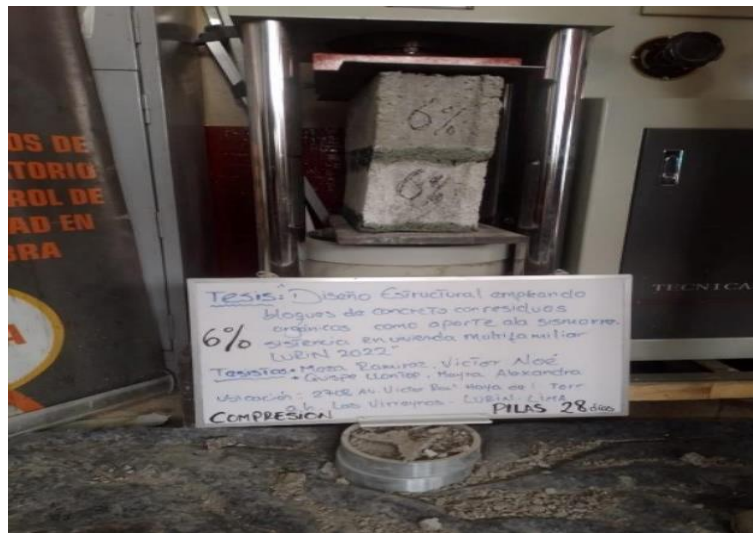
Ensayo de Compresión Axial en Pilas del 6% de Plástico Reciclado
